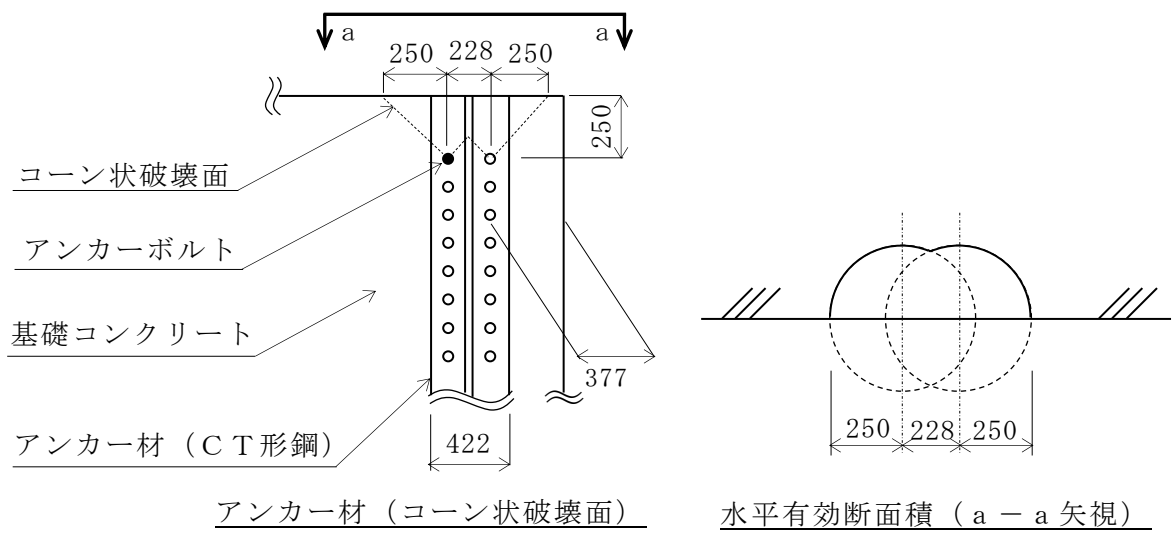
アンカーボルトのコーン状破壊の概要図 (単位: mm)
